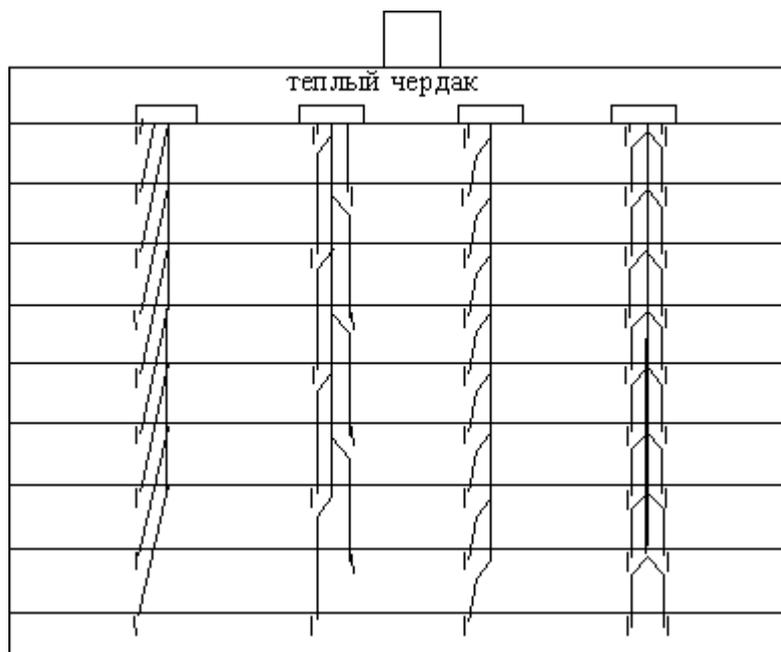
Схемы систем вентиляции в жилых зданиях повышенной этажности
